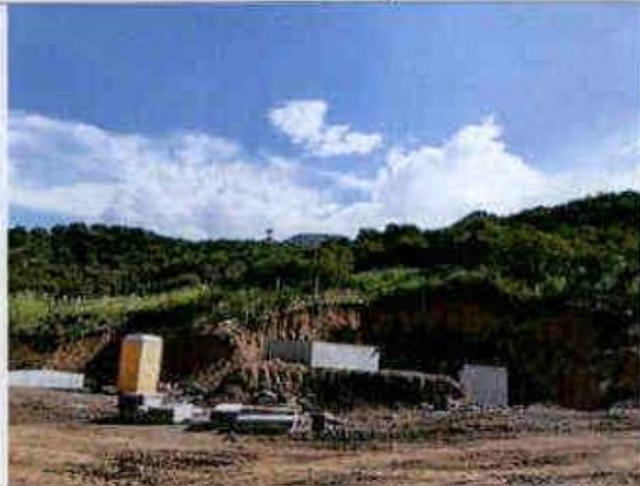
Viga longitudinal para instalación en el Puente Piedras.
